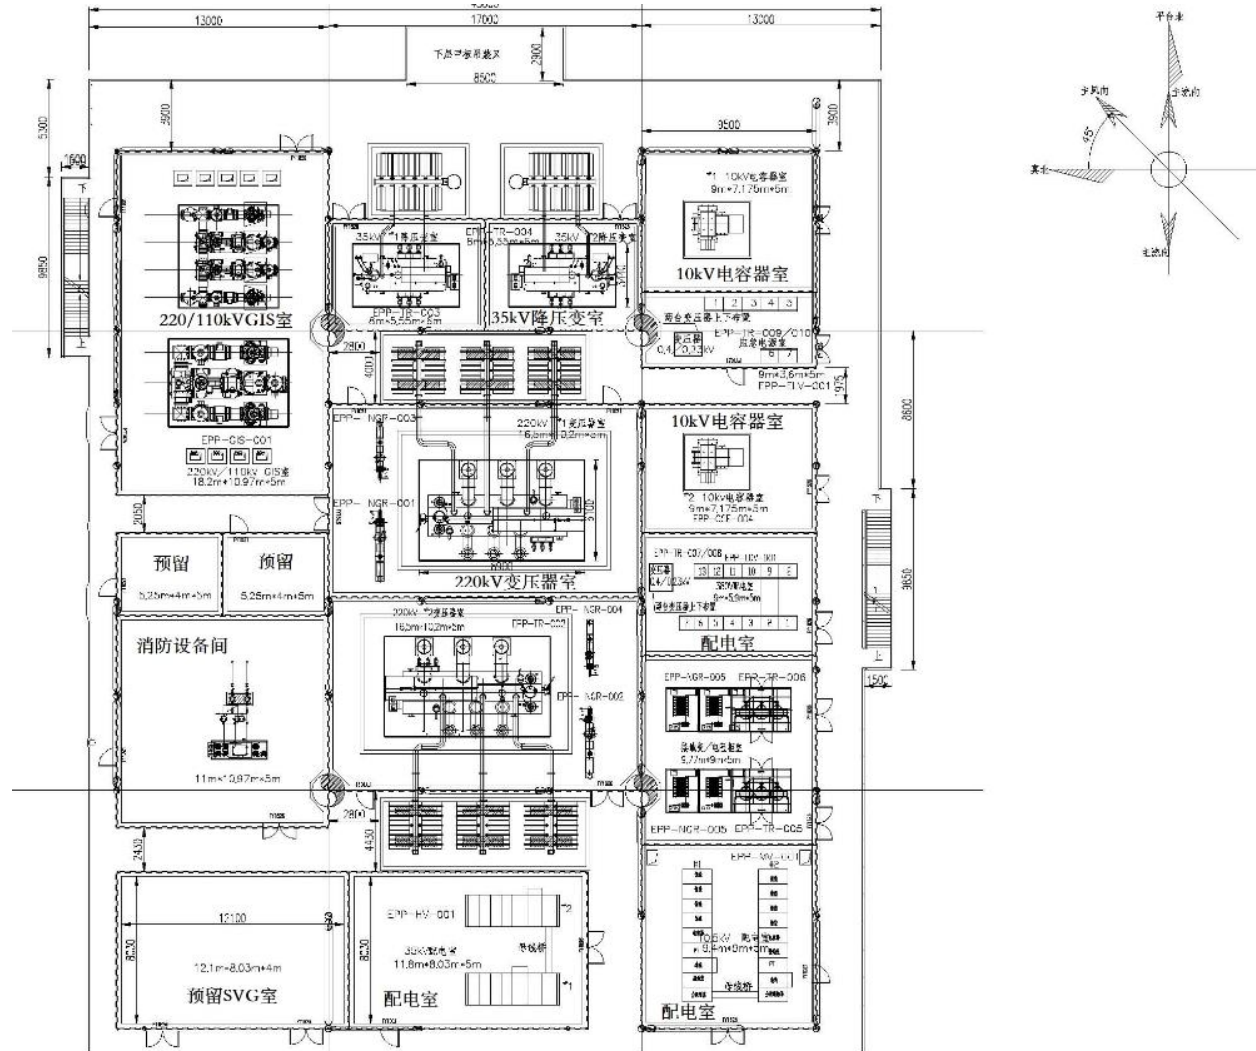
CFD11-1EPP 平台下层甲板平面布置图
